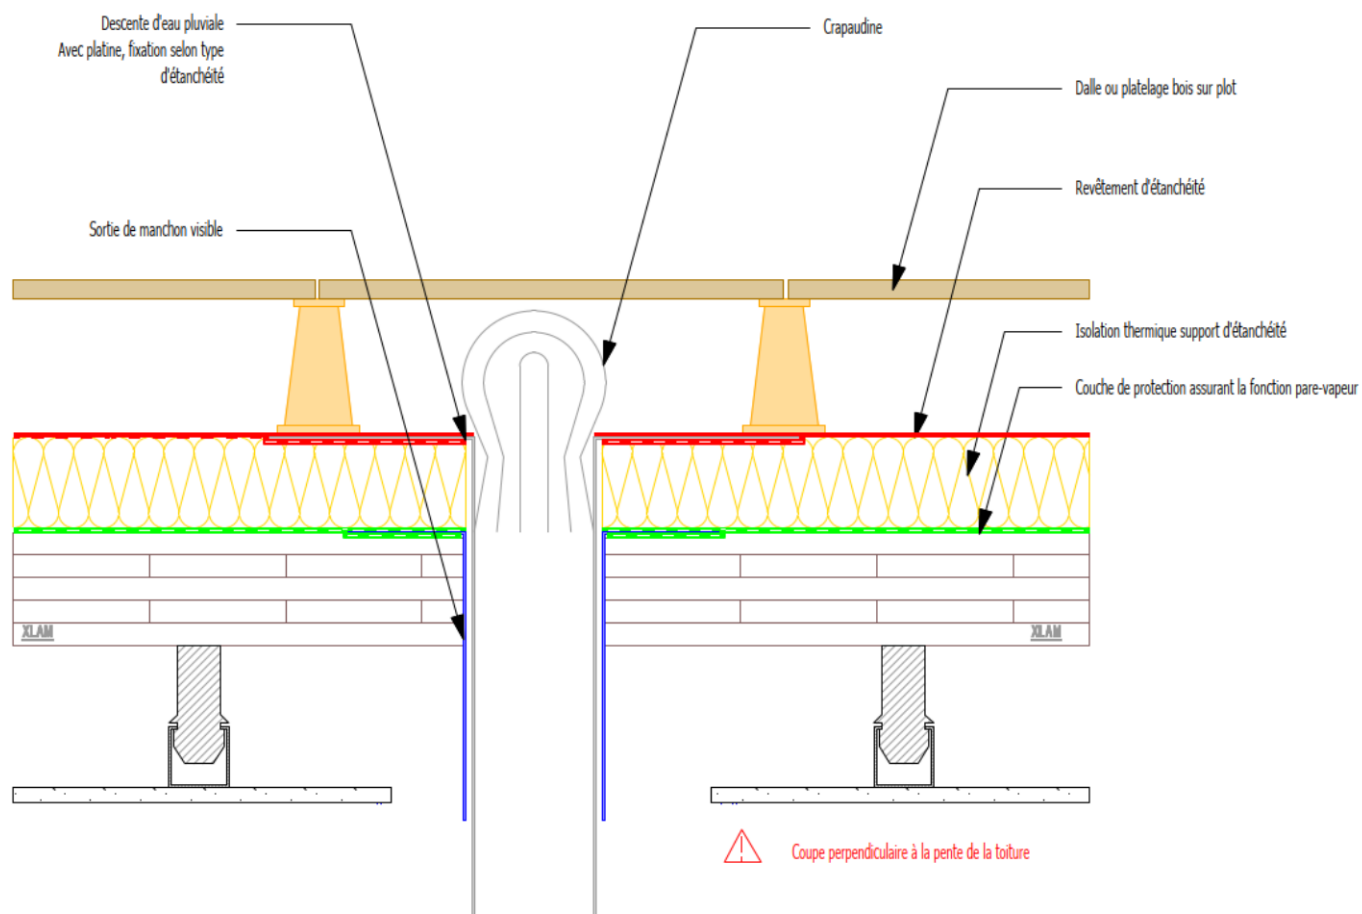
Exemple de traitement d'une descente d'eaux pluviales – toiture chaude accessible aux piétons et au séjour
